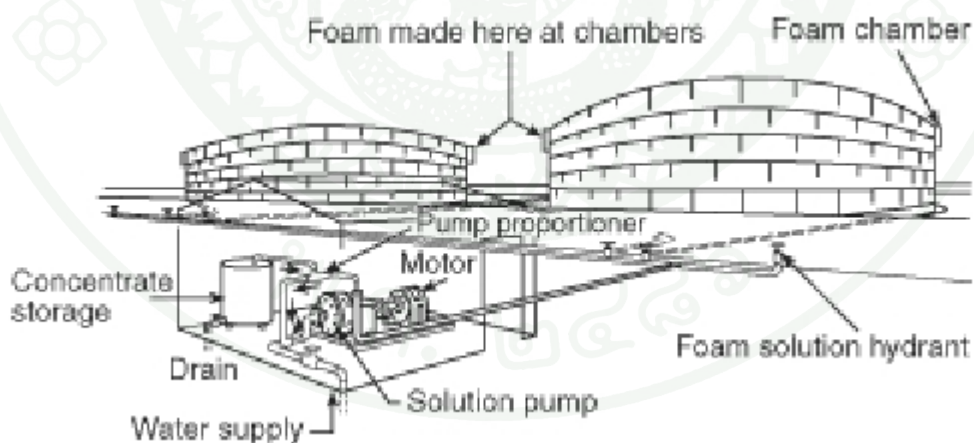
ถึงประเภท Outdoor Open-Top Floating Roof Tanks
